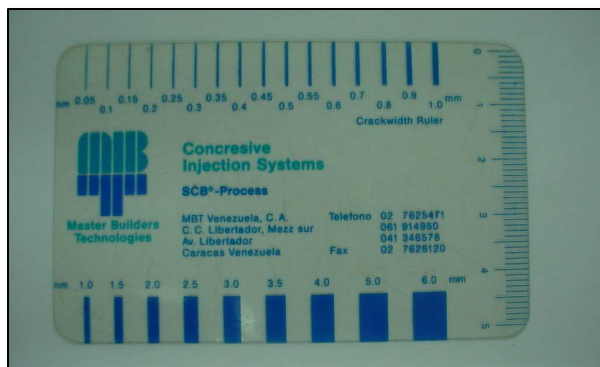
Plantilla utilizada para la medición de ancho de fisuras
